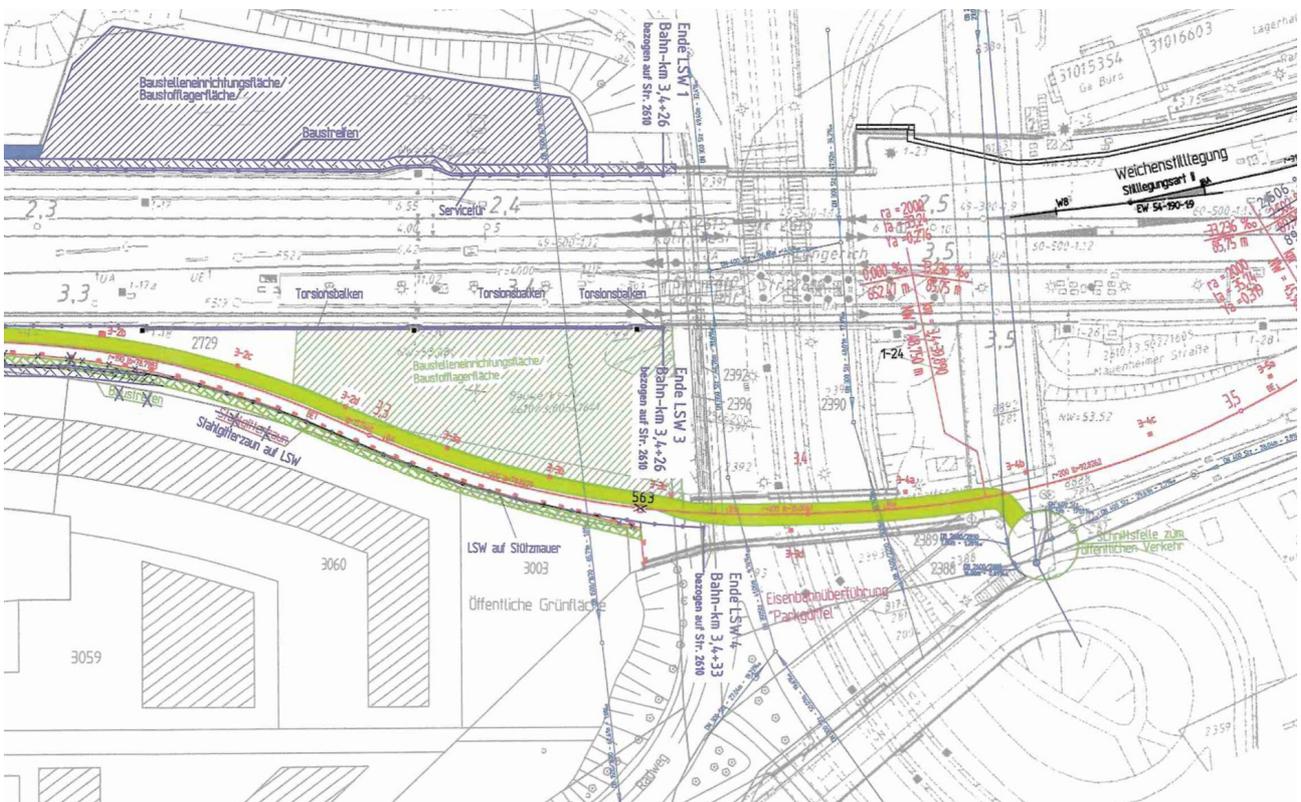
Vorhandene Bahnbrücke als Baustellenzufahrt in der Planung der Deutschen Bahn.
